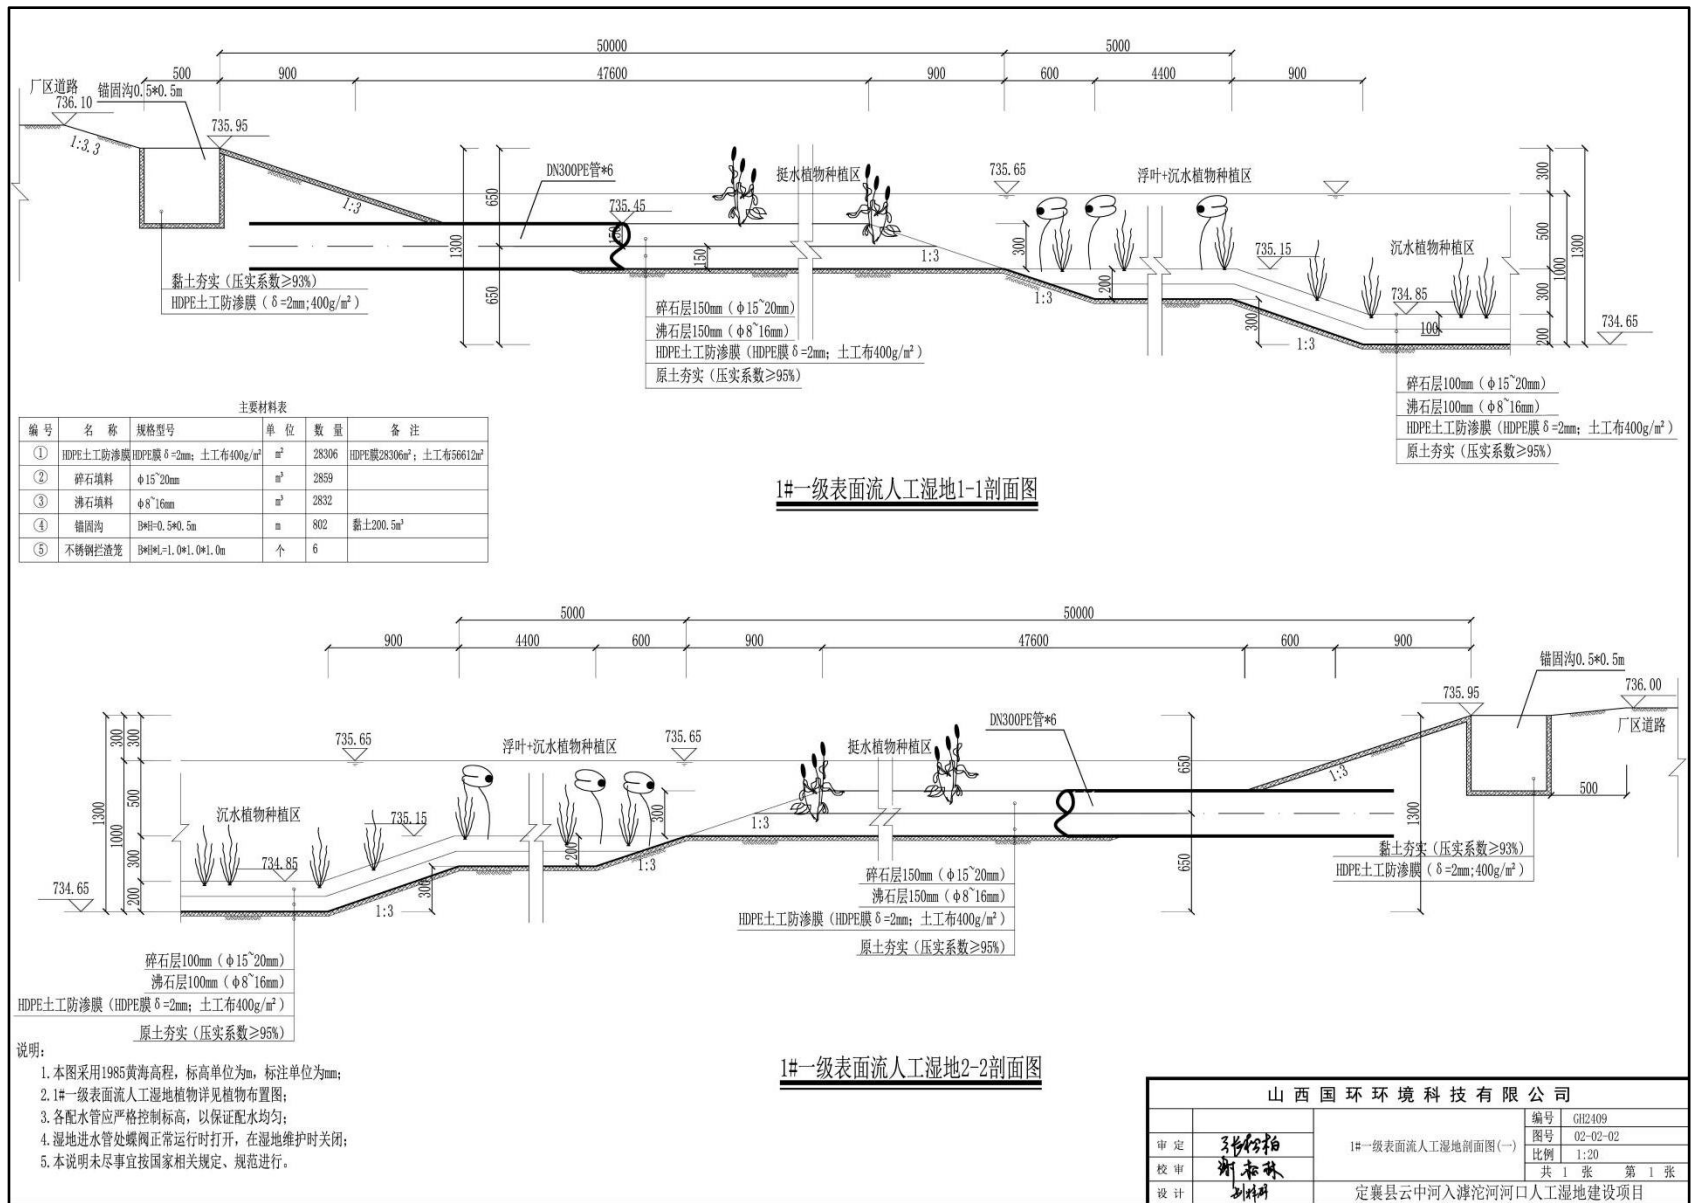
1#一级表面流人工湿地剖面图 (1)
